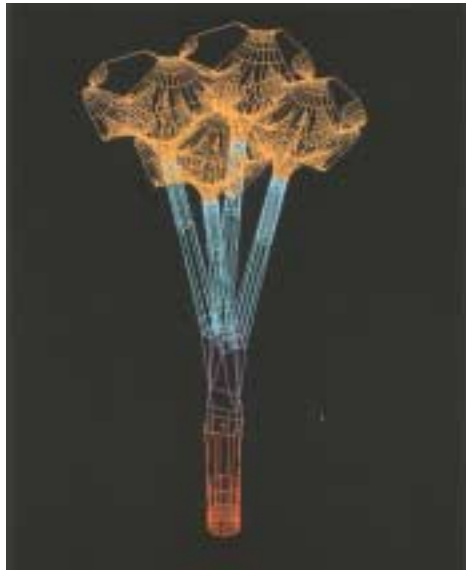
Desenho em CAD das etapas para finalização dos pilares indicados na FIG. 5.34
